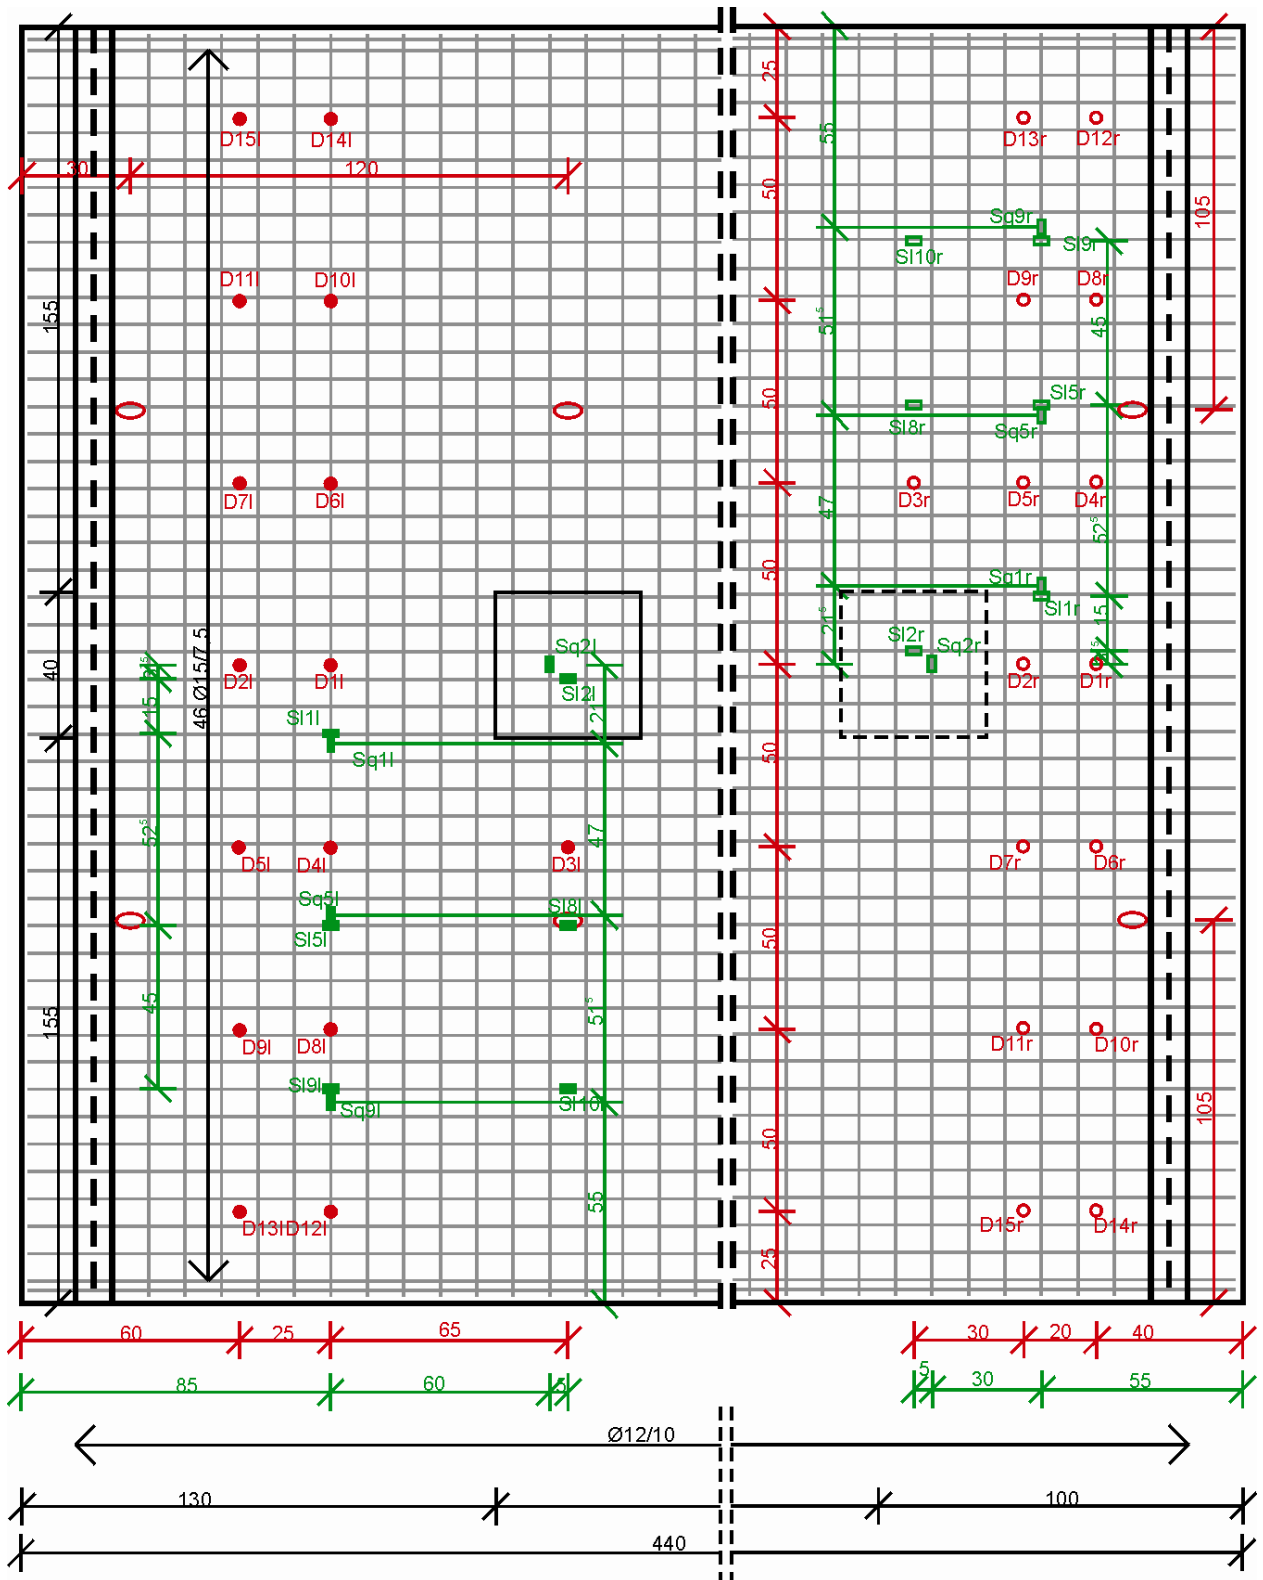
Messtechnikplan vor Betonage für die Versuche S35C und S35A: Untere Bewehrungslage, Stahl-DMS, Dickenmessung und Lage der Transportanker
